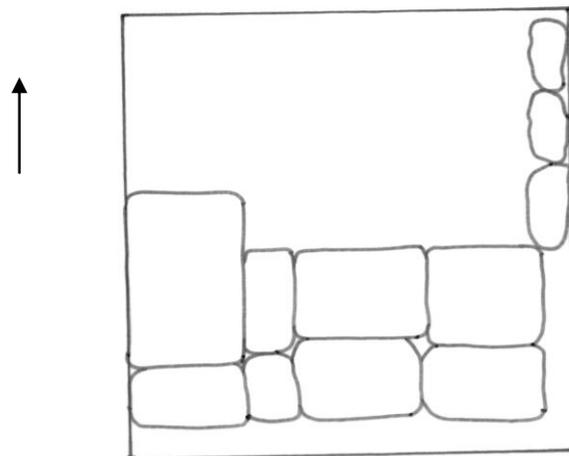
Dibujo de planta del muro excavado en el pozo 3
